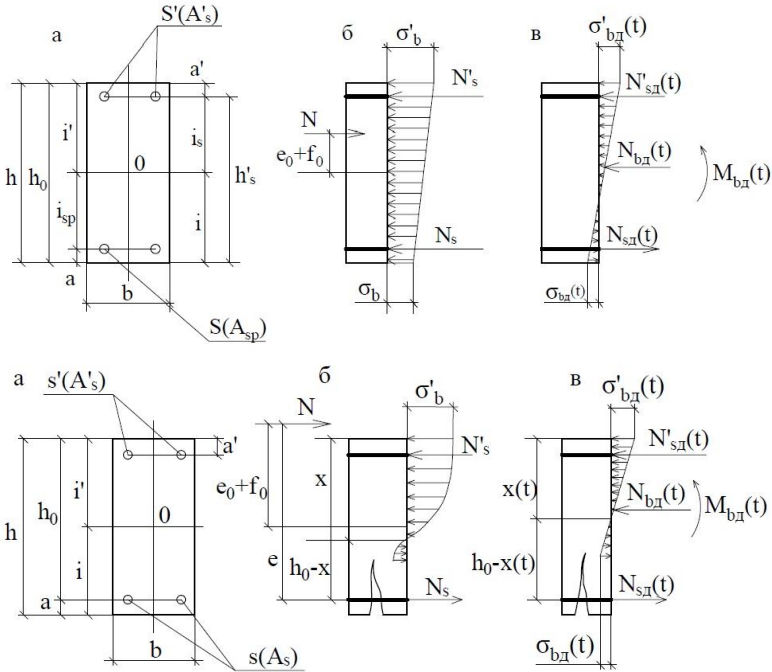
Напряженно-деформированное состояние сжатого стержня, работающего без трещин и с трещинами в растянутой зоне: а - поперечное сечение; б - эпюра начальных напряжений; в - эпюра дополнительных напряжений
